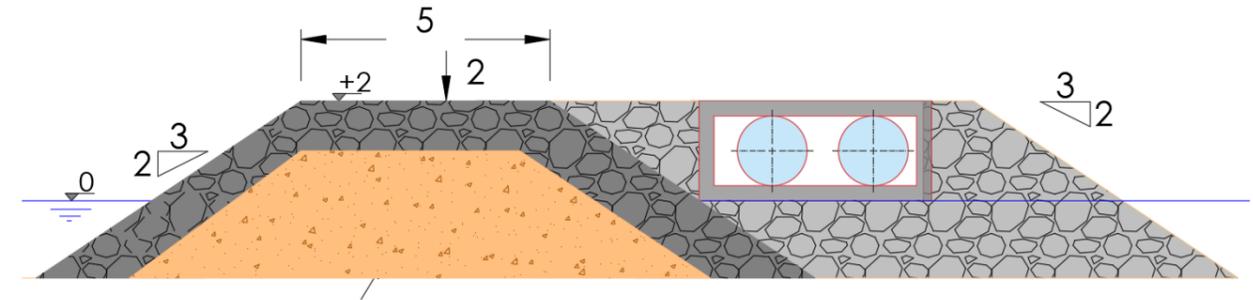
Posible sección a futuro para el encauzamiento de pluviales
